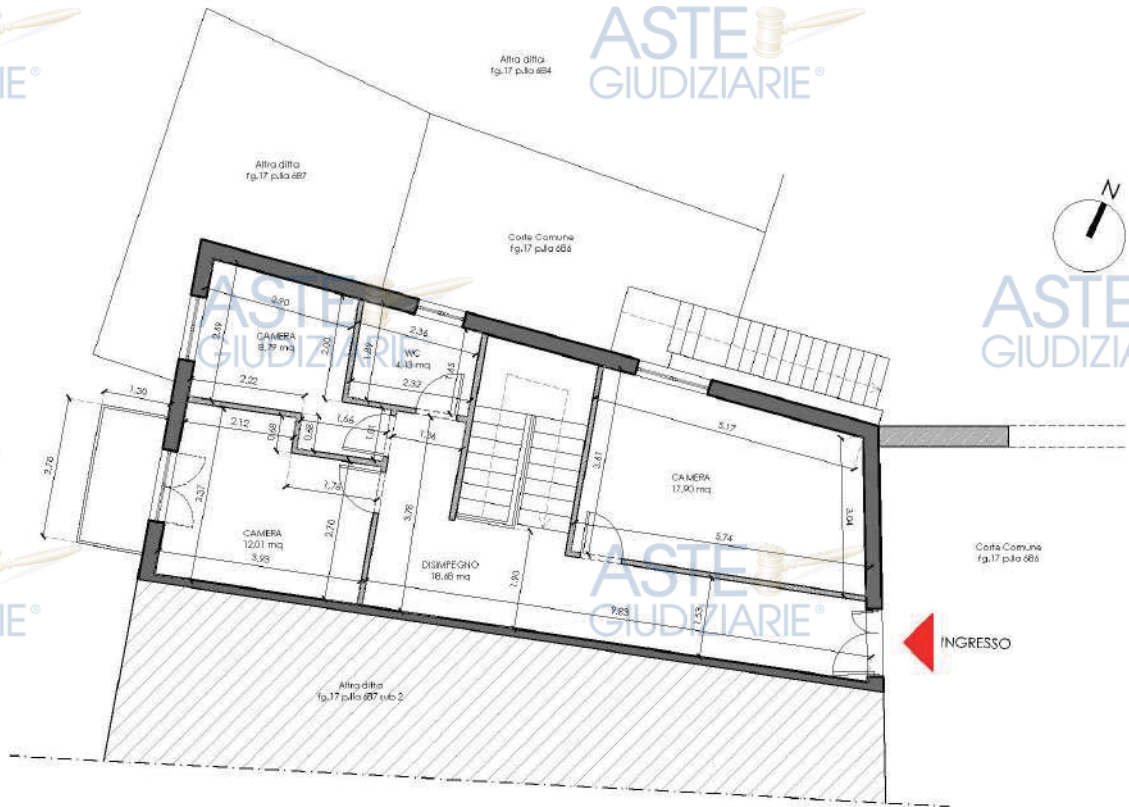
Rilievo Lotto Unico Stato di fatto _ pianta piano terra (Allegato 6E)
